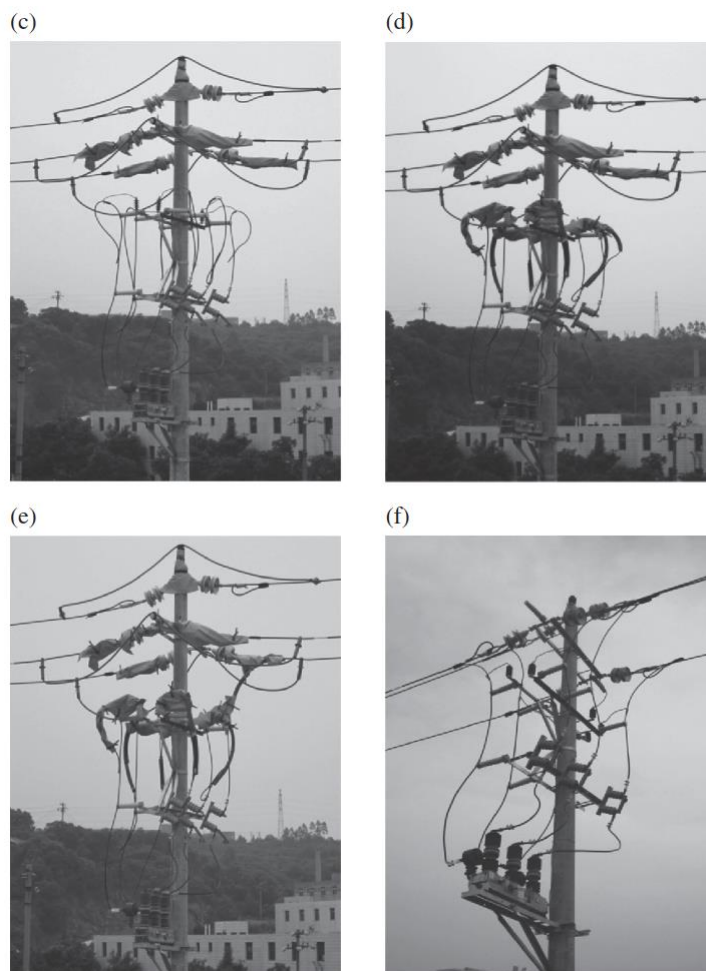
(Продолжение) Установка расцепителей на опоры под нагрузкой (II). (с) снятие перемычек с натяжной опоры; (d) изоляция проводов; (e) подсоединение свинцовых проводов; (f) снятие байпасов маневровых проволок и изолирующих покрытий.
